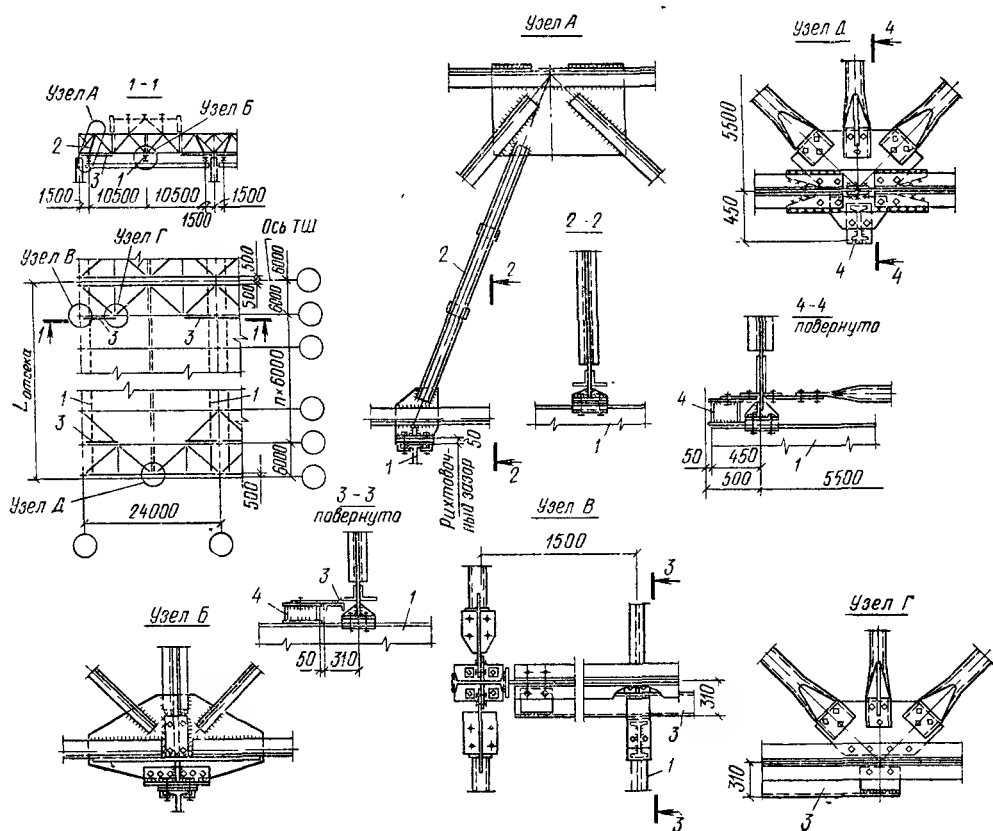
Крепление к конструкциям покрытия путей подвешенного транспорта
